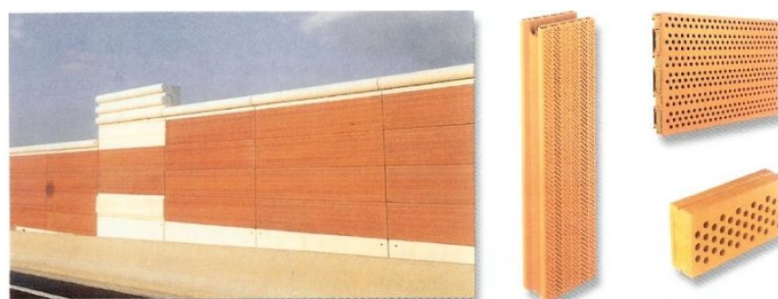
Tijolo de elevada absorção acústica [44]
